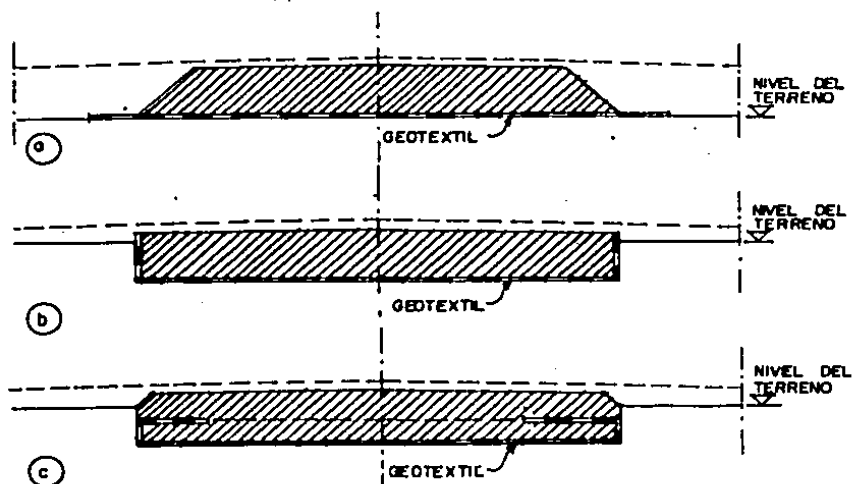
CONSTRUCCION DE CAMINOS CON GEOTEXTILES
